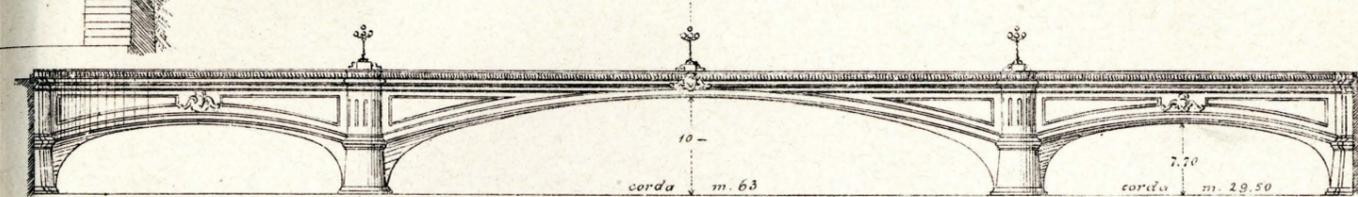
Altro Progetto di ponte in muratura dell'Ing. Ferria.
